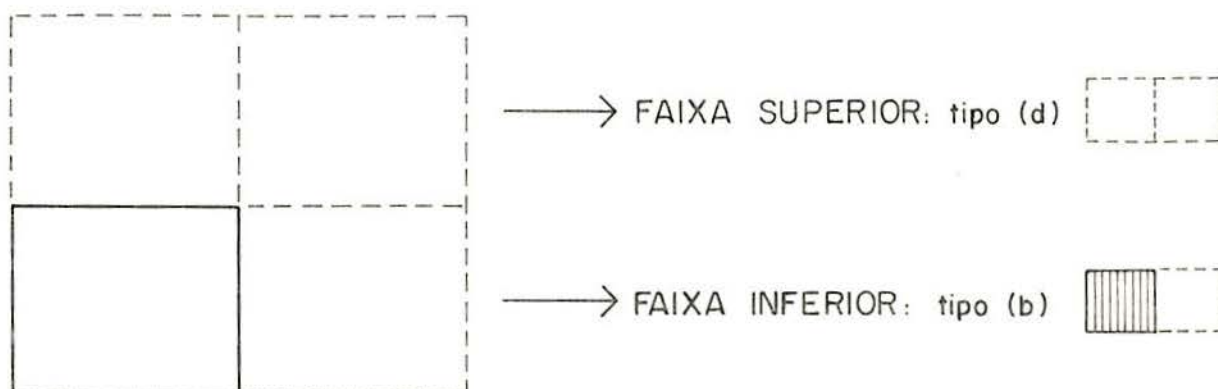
Representação da configuração da laje retangular por faixas horizontais
